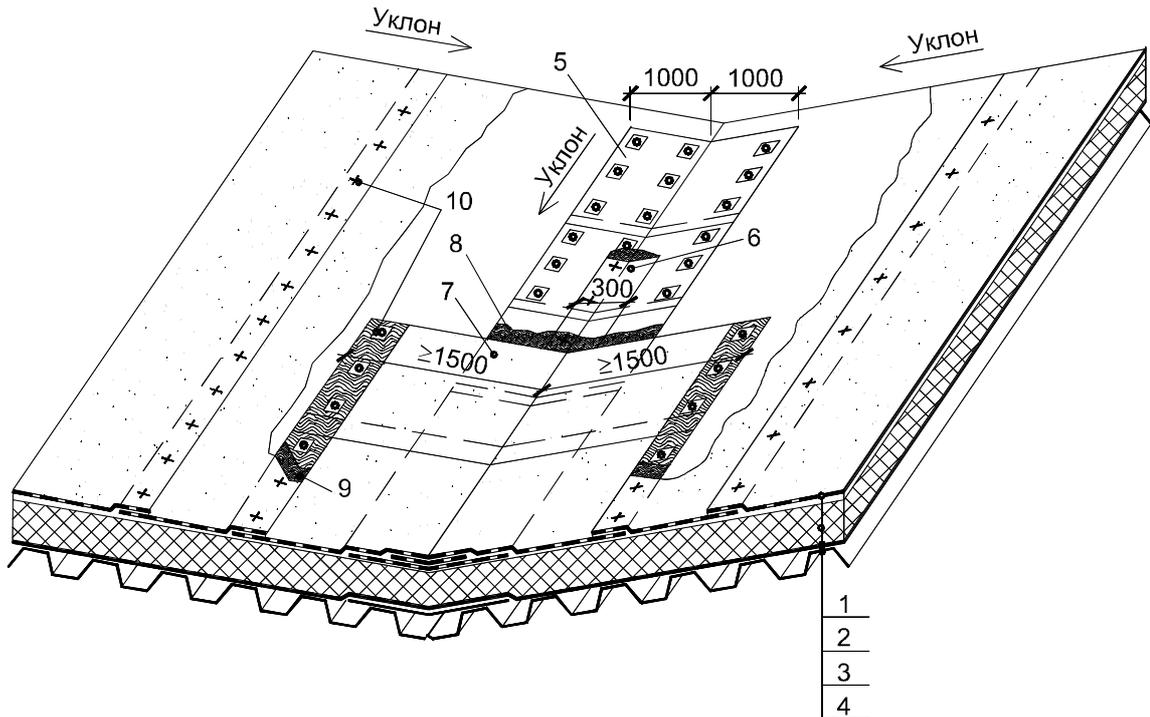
Схема раскладки рулонных материалов и их закрепления при устройстве однослойной кровли (уклон кровли к парапету)
